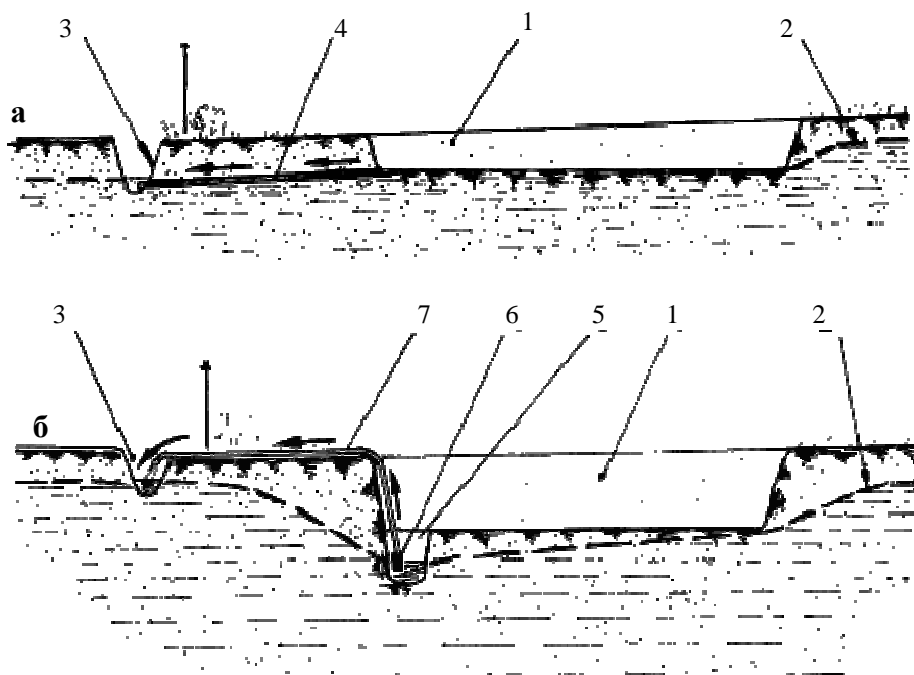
Улаштування дренажу будівельного майданчика: а – природний; б – примусовий; 1 – котлован (траншея); 2 – рівень ґрунтових вод; 3 – кювет придорожній; 4 – труба дренажна; 5 – прямокутний; 6 – насос; 7 – труба водовідливна
